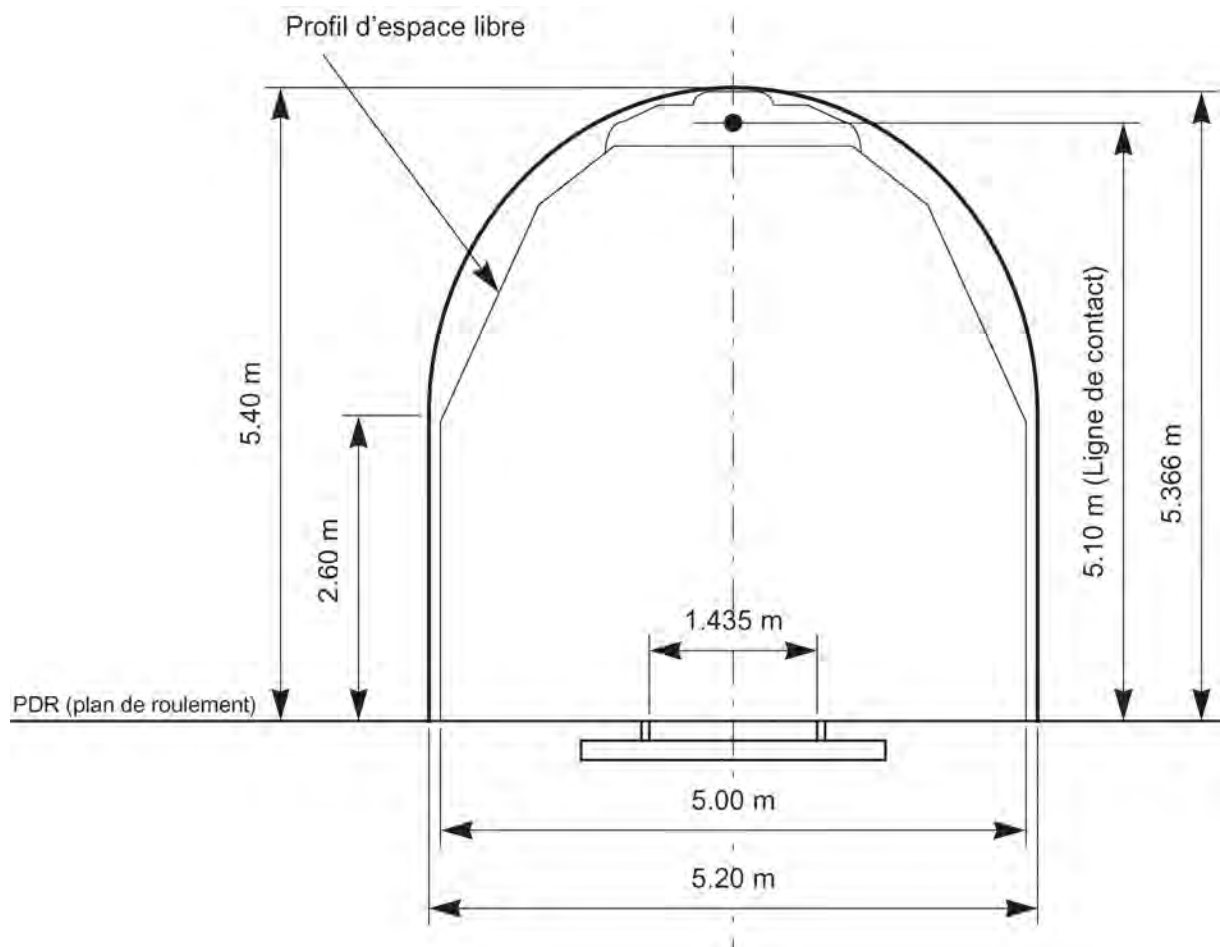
Profil d'espace libre nécessaire pour l'OCF 2 et profil du tunnel
